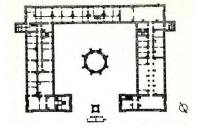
План 1 и 2 этажа Караван-сарая
